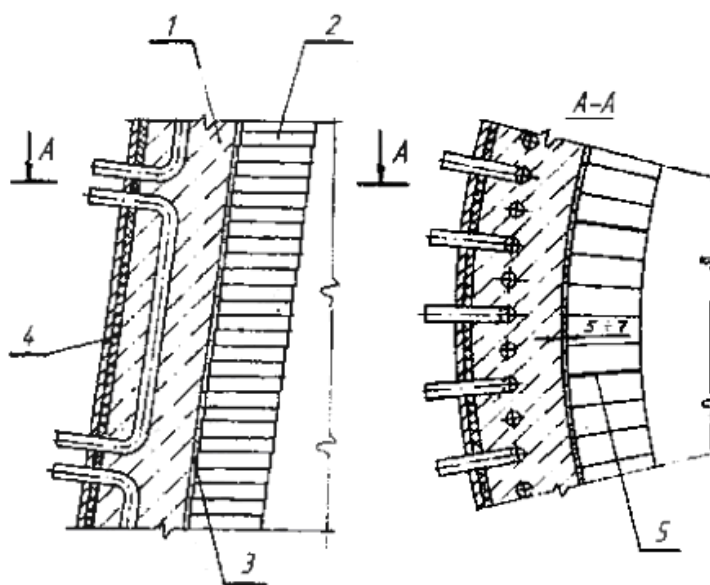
Охлаждение кладки нижней части шахты бетонными водоохлаждаемыми панелями:
